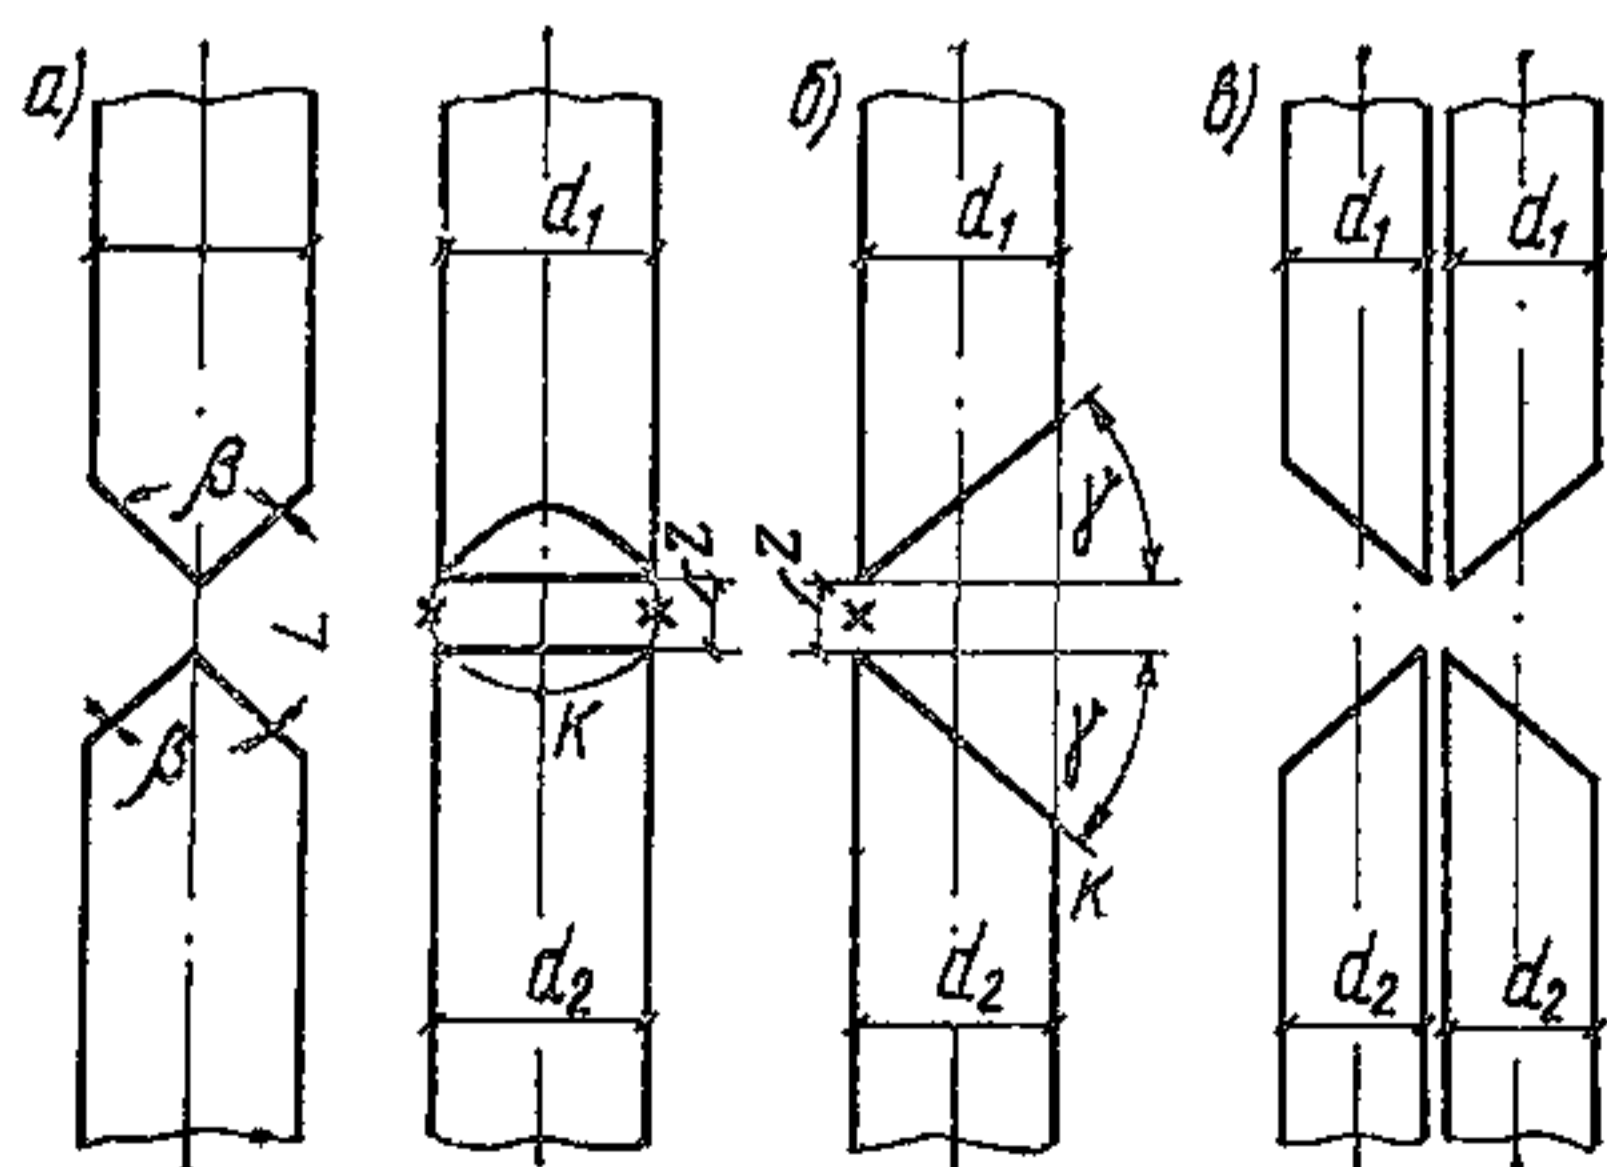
Разделка торцов вертикальных стержней для дуговой сварки многослойными швами без дополнительных технологических или конструктивных элементов
